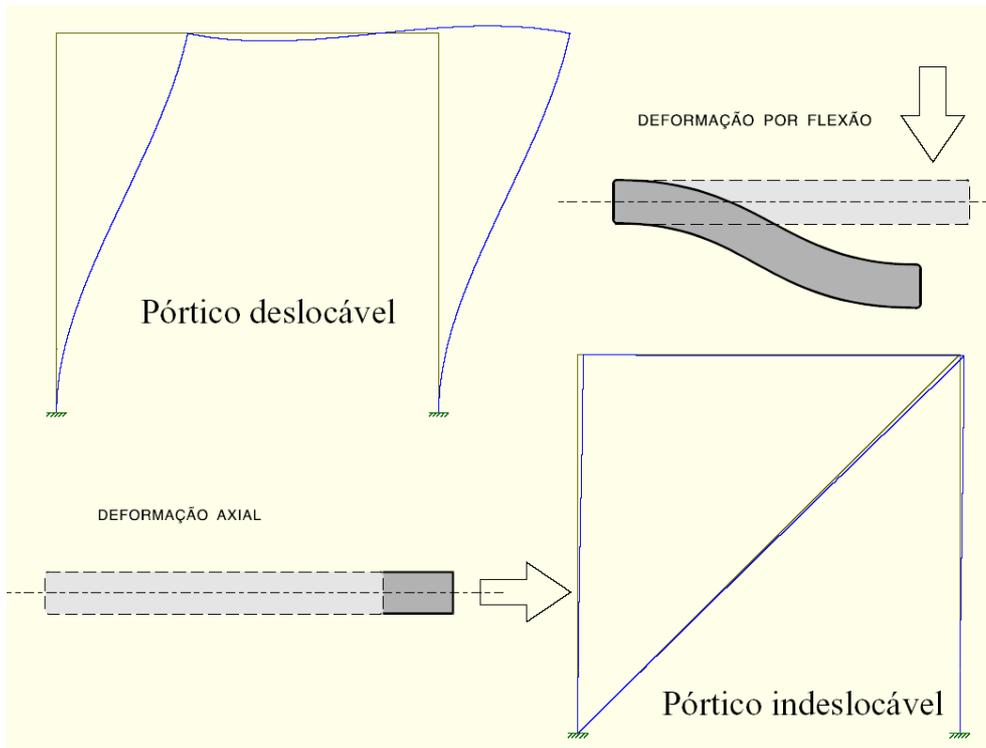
De pórtico deslocável para indeslocável por introdução de um contraventamento [4]
